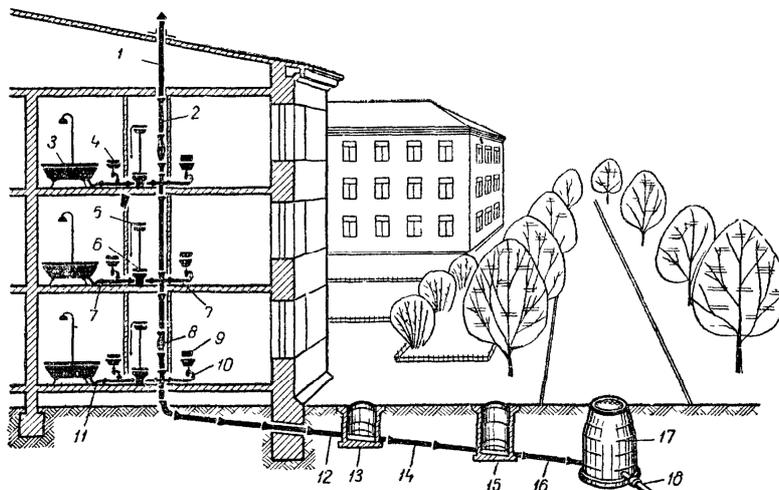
Схема внутренней канализации: 1 — вытяжная вентиляционная труба; 2 — стояк; 3—ванна; 4—умывальник; 5 - смывной бачок; 6 — унитаз, 7 —отводная труба; 8 — ревизия; 9 — мойка или раковина
